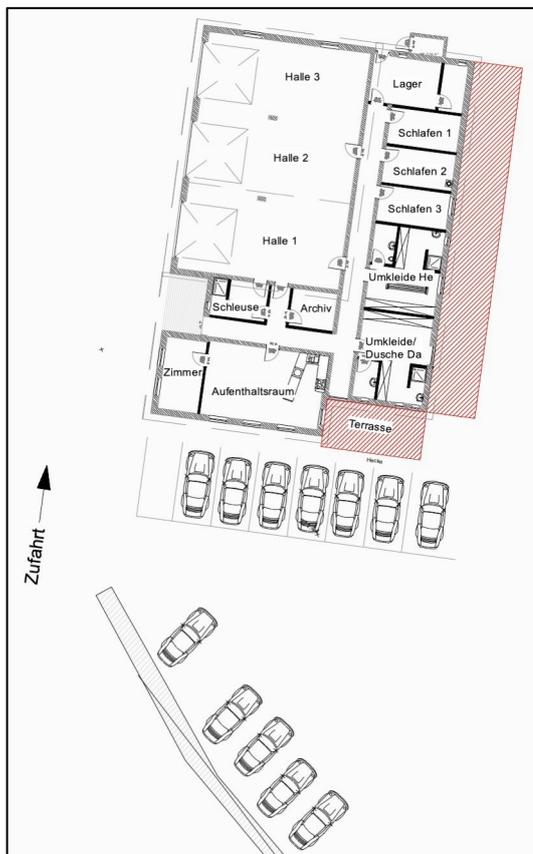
Lageplan Rettungswache - Architektenentwurf 06/24, G. Schymik, Gießen
